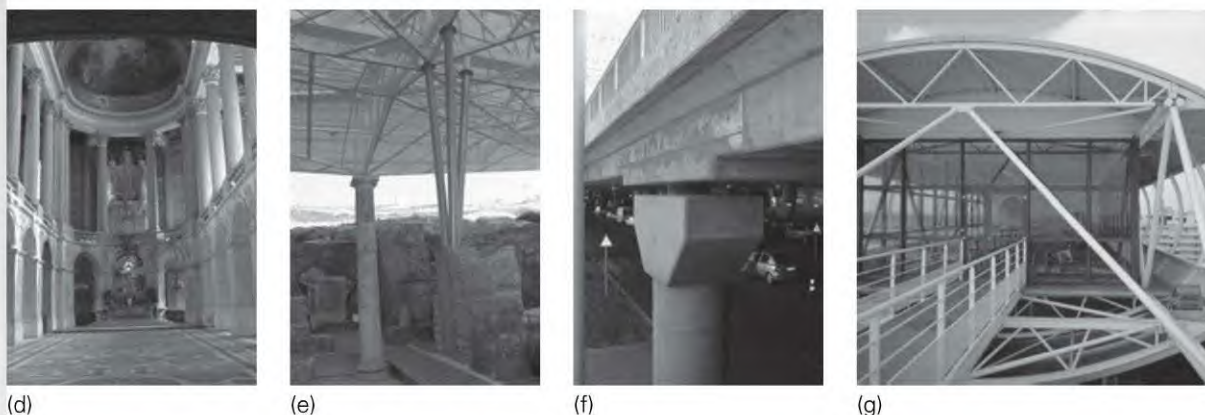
(suite) D'une liaison articulée à une architecture d'articulations.
